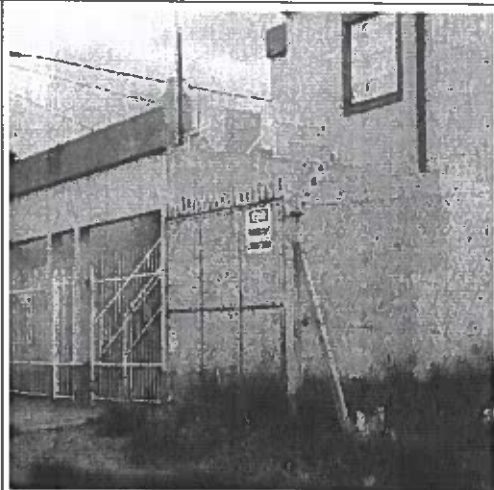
Viviendas recientemente construidas y en construcción, sobre los terrenos contaminados donde se encontraba la Fundición Geotécnica.
